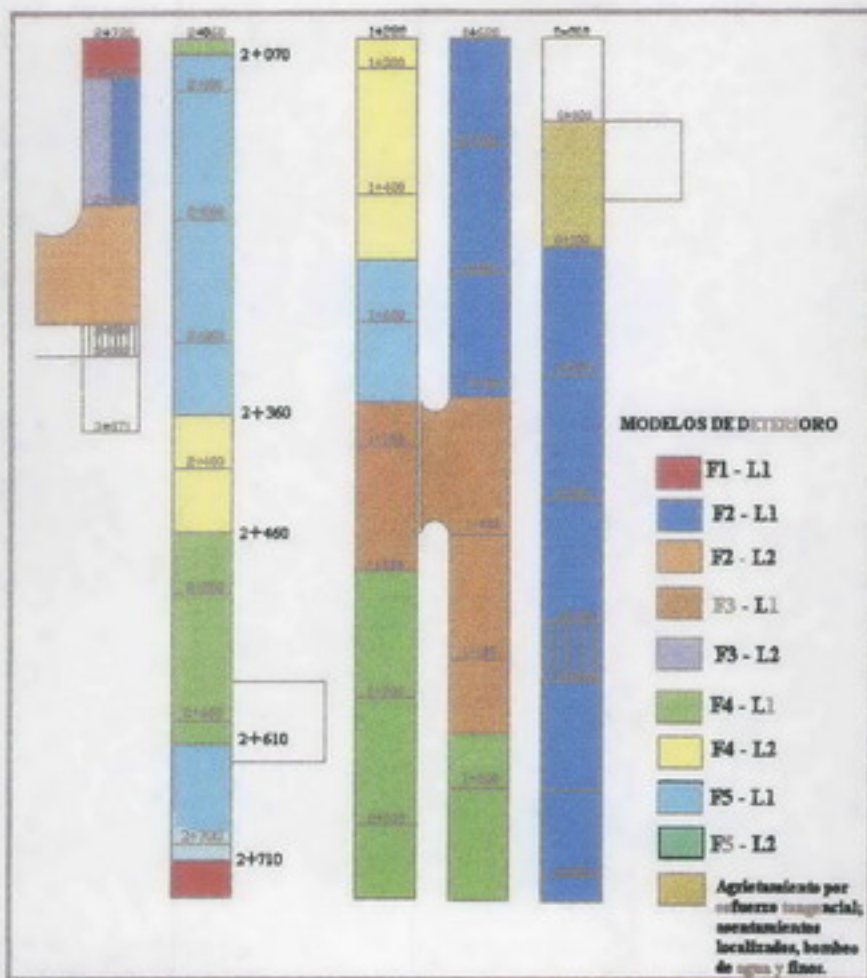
Discretización de los tramos del pavimento de la pista por patrón típico de deterioro.
